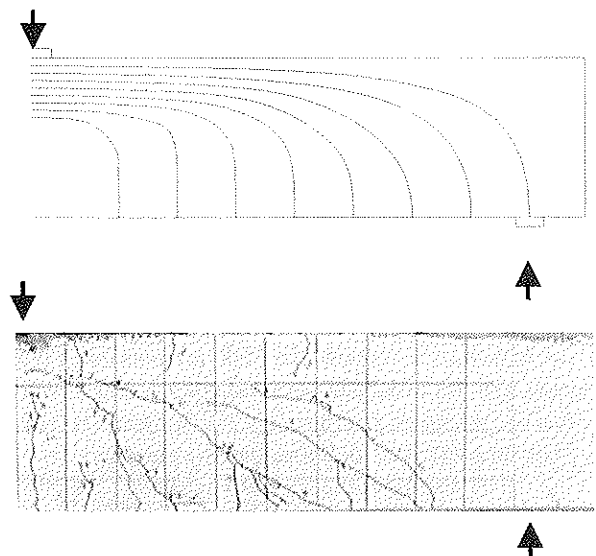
Trayectorias de la tensión principal de compresión en una viga no fisurada y fotografía de una viga de hormigón fisurada por cortante.
